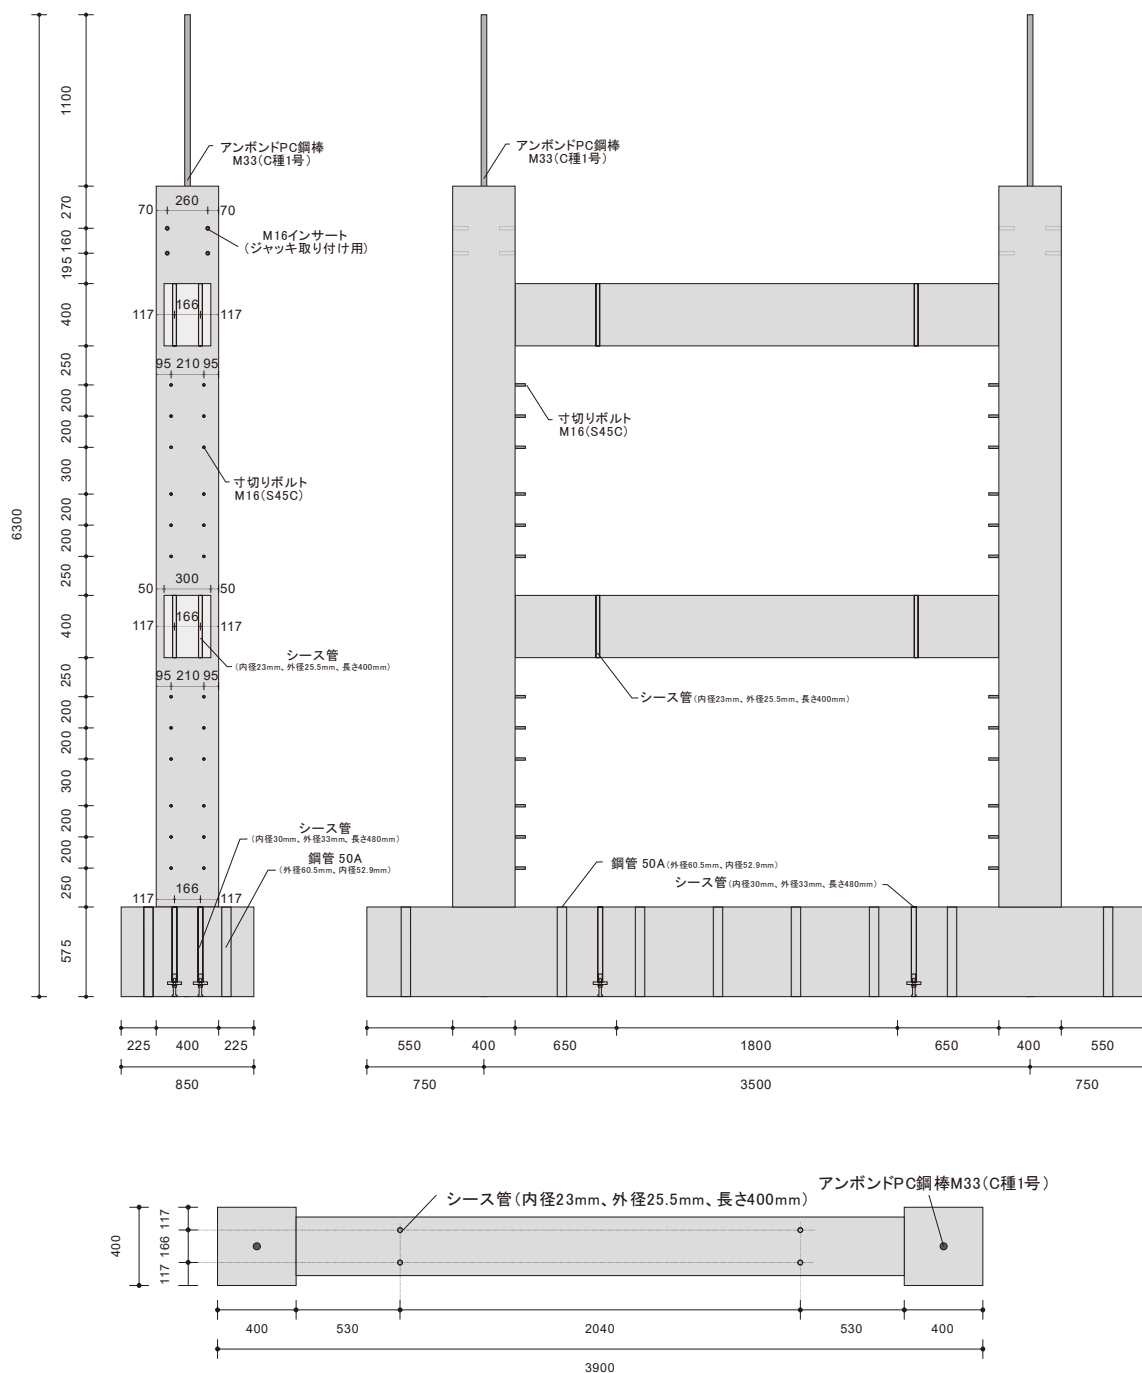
試験体 A の RC 部分の寸法図 (単位:mm)
